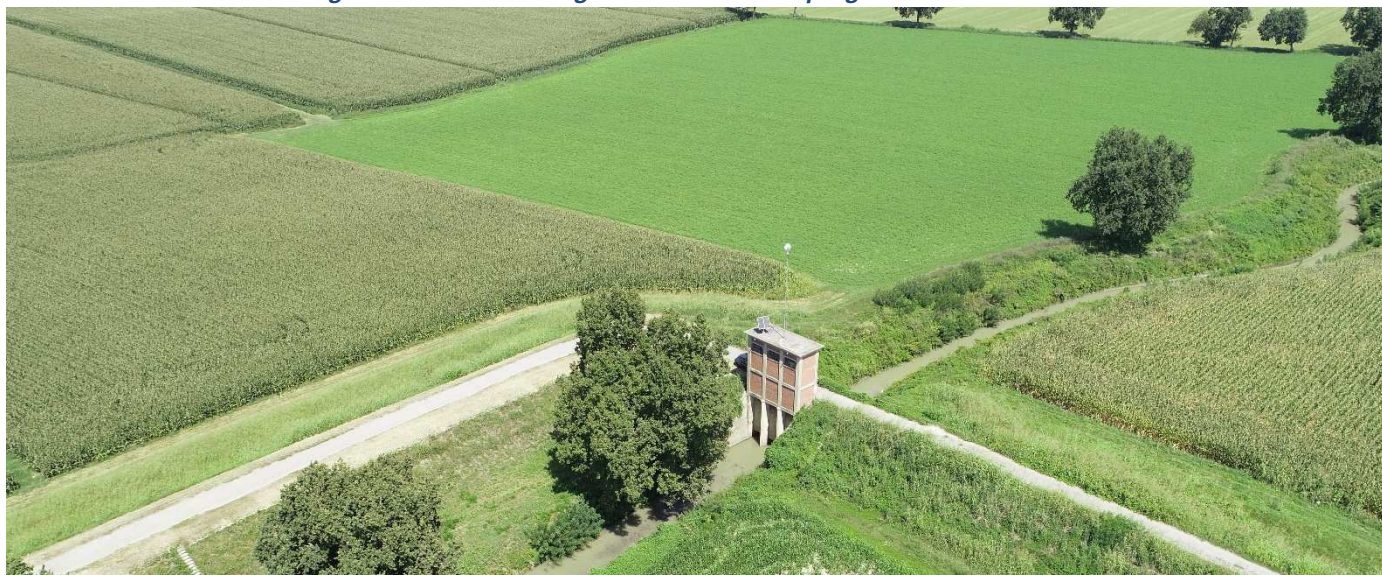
Struttura di regolazione – Stato di fatto: vista da valle
